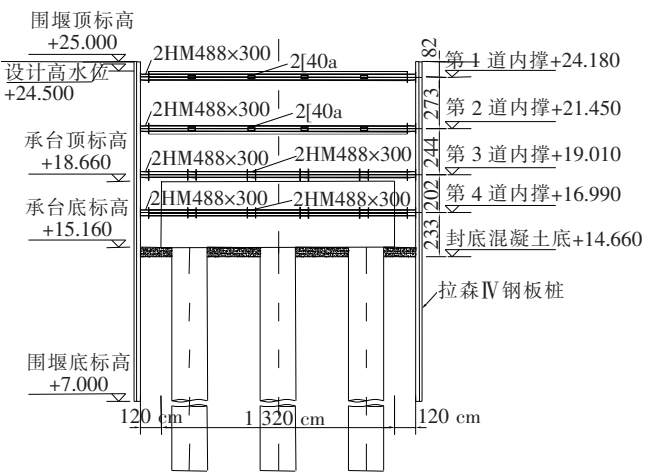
钢板桩围堰立面布置图(除标高单位为 m 外,其余:mm)
